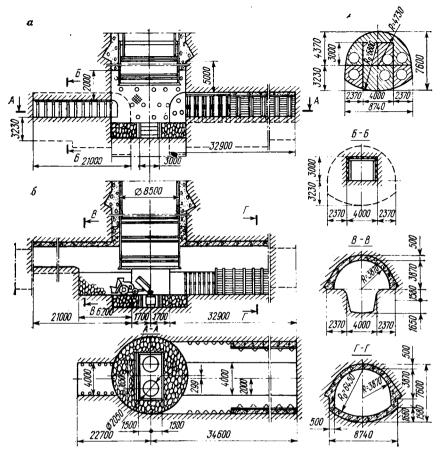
Схема строительства сопряжения ствола с горизонтальной выработкой околоствольного двора слоями сверху вниз с проведением по своду сопряжения предварительной выработки:
